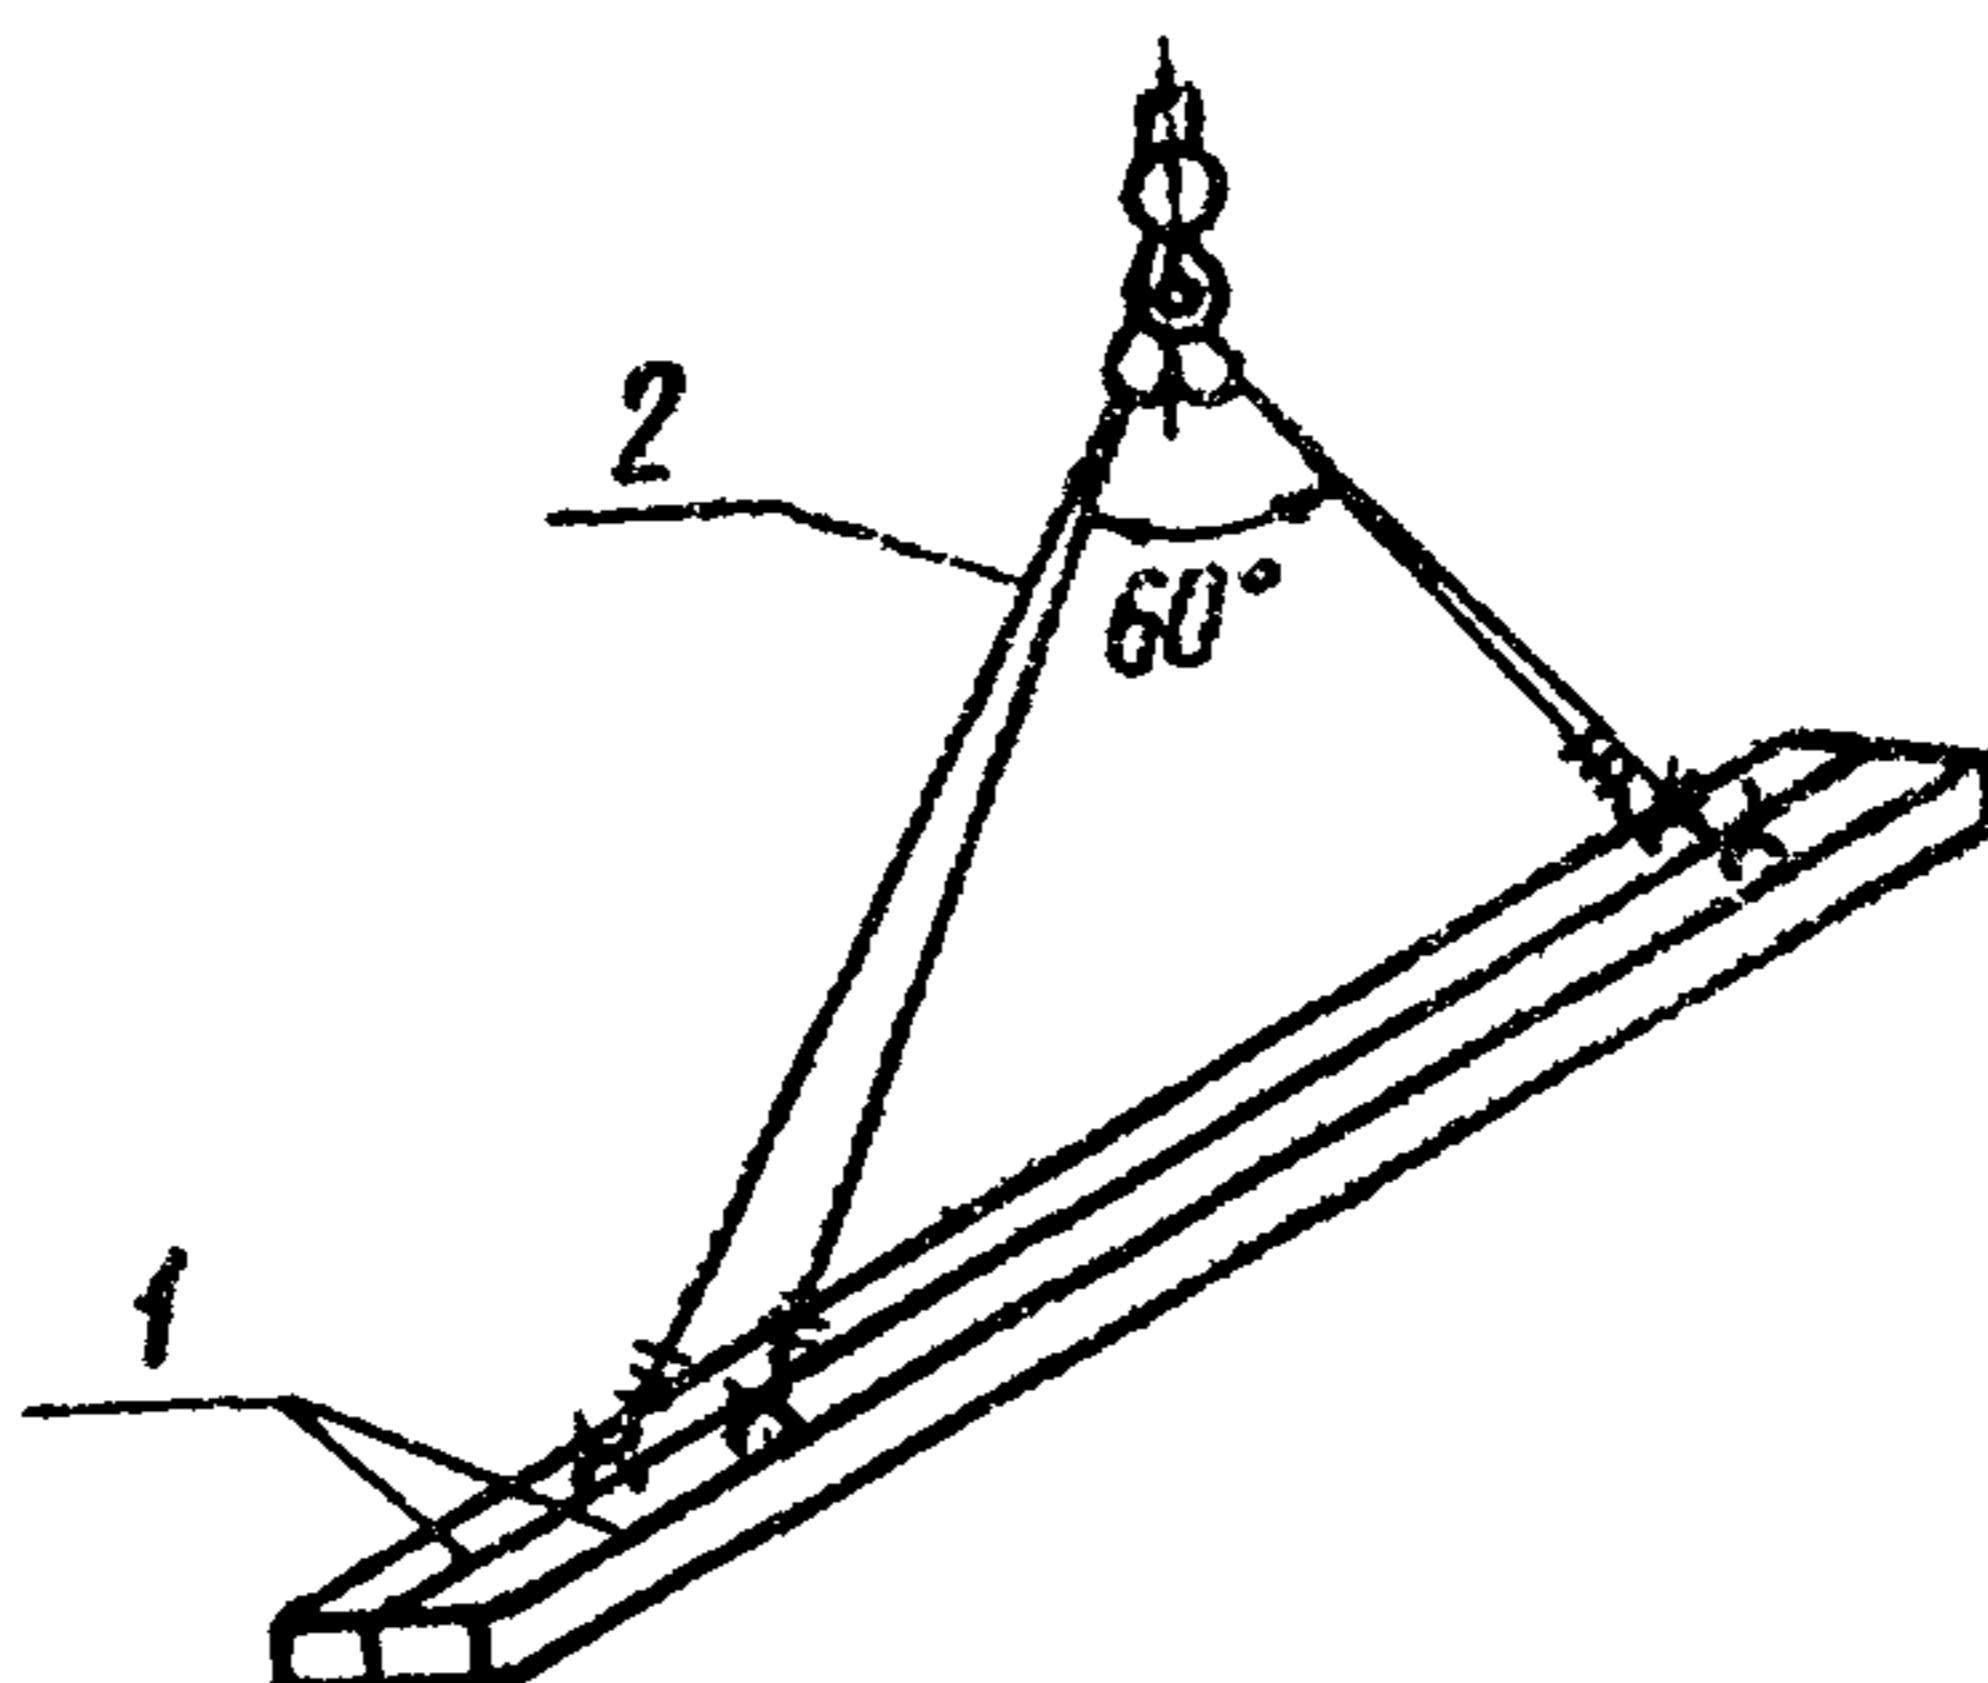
Схема строповки свай при раскладке: 1-сваи; 2-четырехветвевой строп грузоподъемностью 5 т
